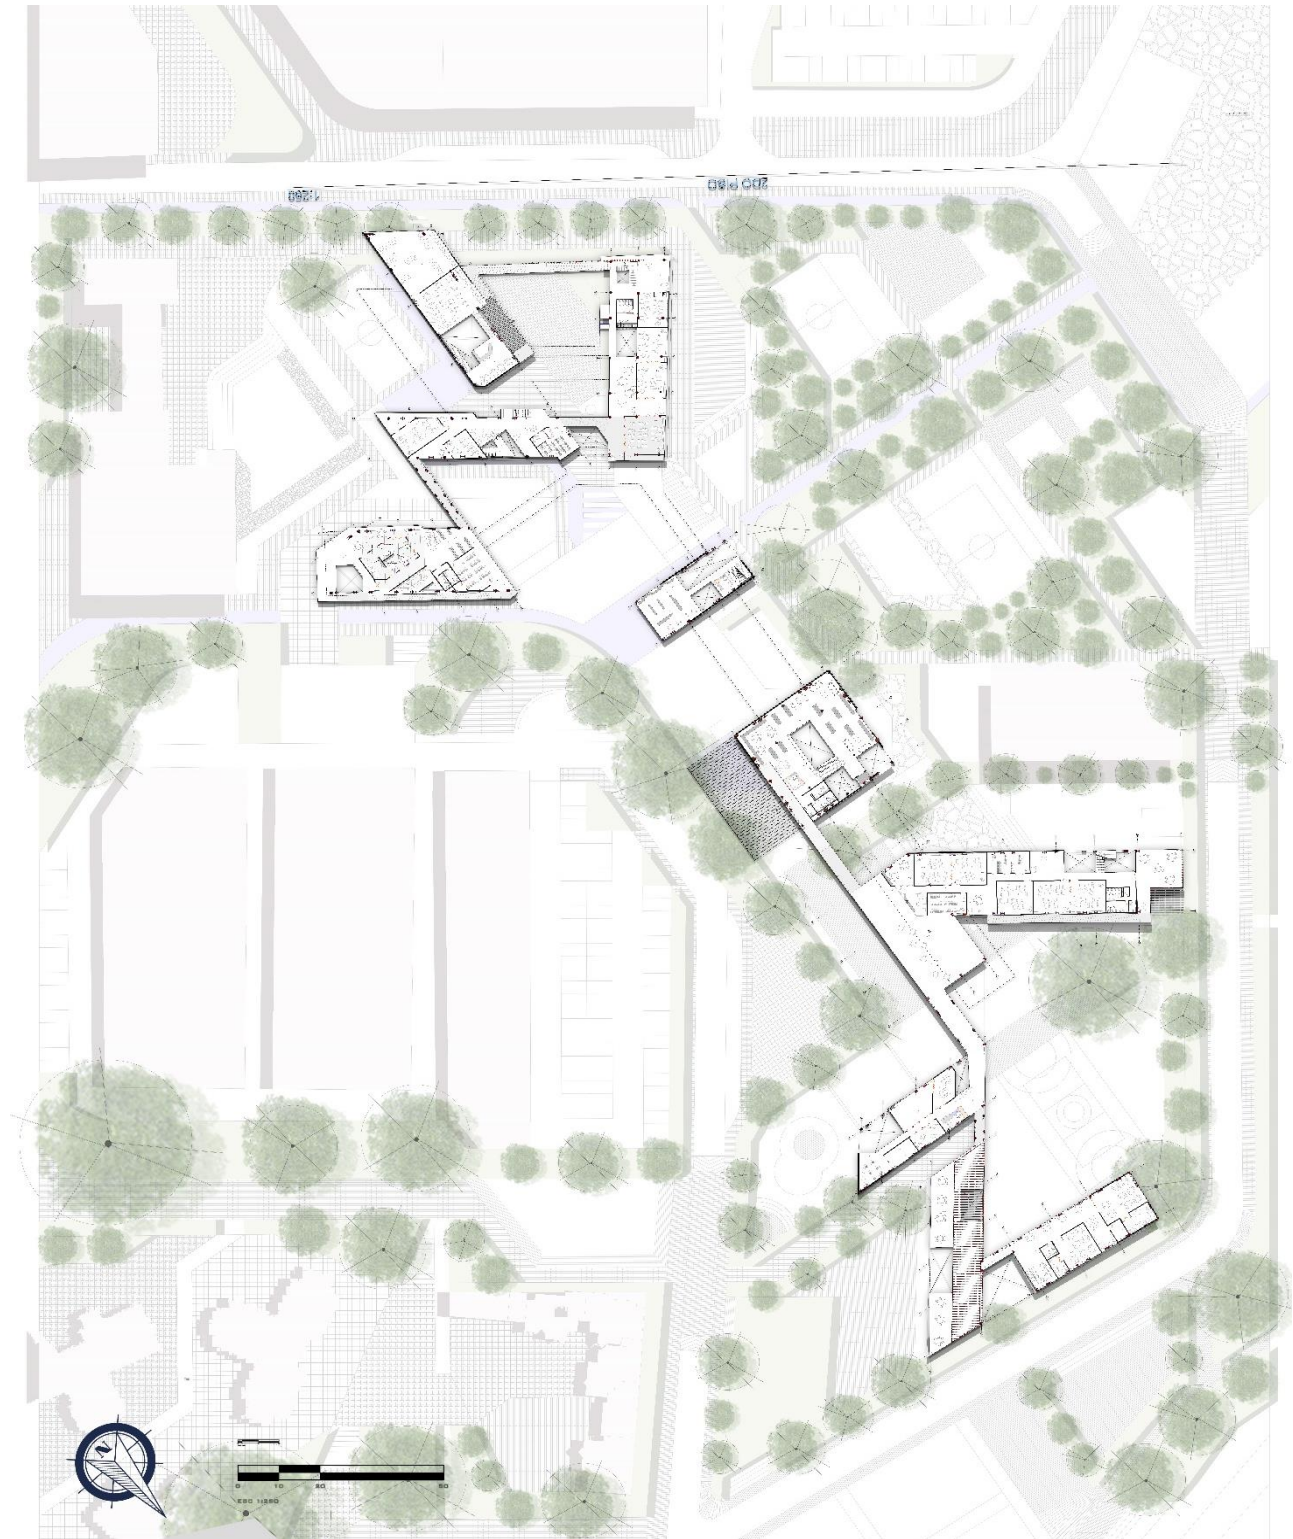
Planta segundo piso- Equipamiento Centro Educativo.
